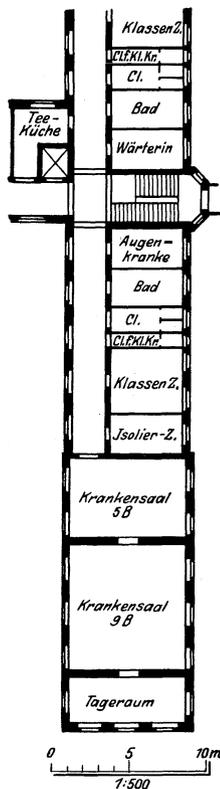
Frankfurt a. O., städt. Krankenhaus, Bettenhaus.
